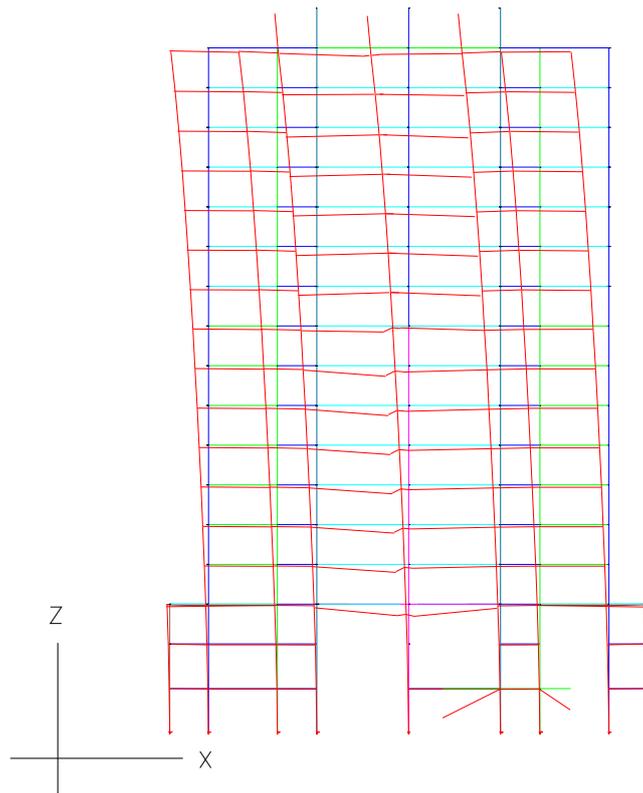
Pórtico do Edifício 04 em sua configuração deformada submetido apenas ao carregamento permanente e acidental (cargas verticais) – plano XZ
